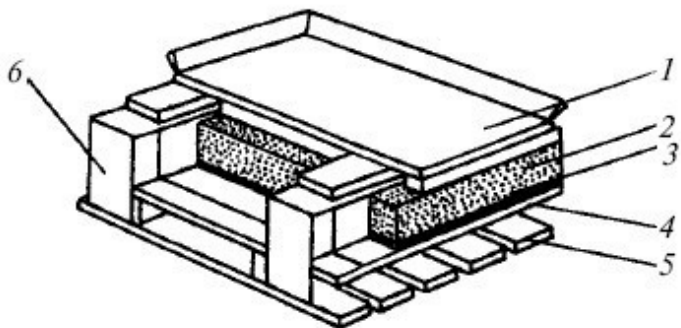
Задействование плит из кокосового волокна для акустической и термической изоляции полов: 1 – пол; 2 – плиты из кокосового волокна; 3 – гидроизоляция; 4 – слой теплоизоляции; 5 – доски, укладываемые на перекрытия; 6
